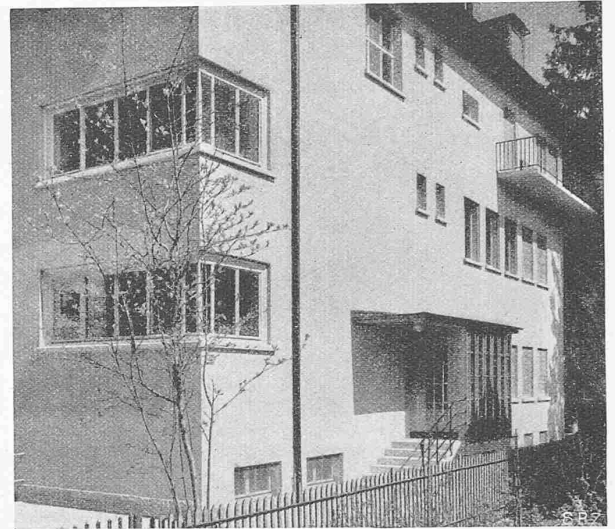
Südecke mit Treppenhaus im neuen Schulhaus
